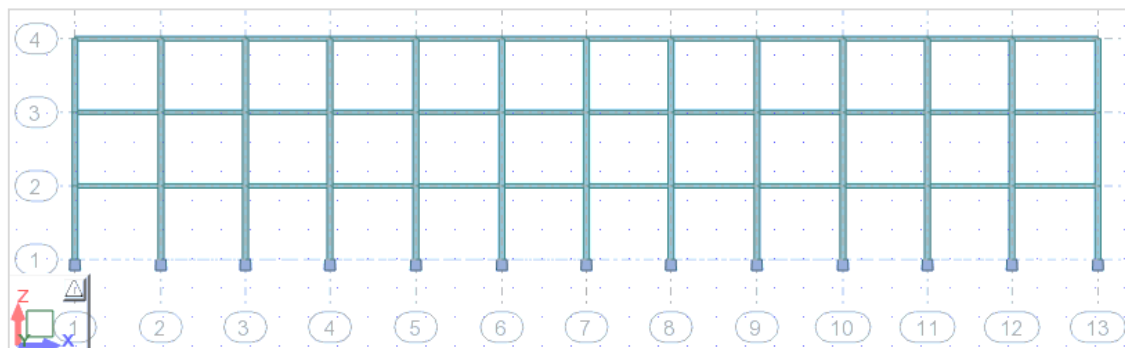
Configuración Vertical Eje X. Casas C41-P9
